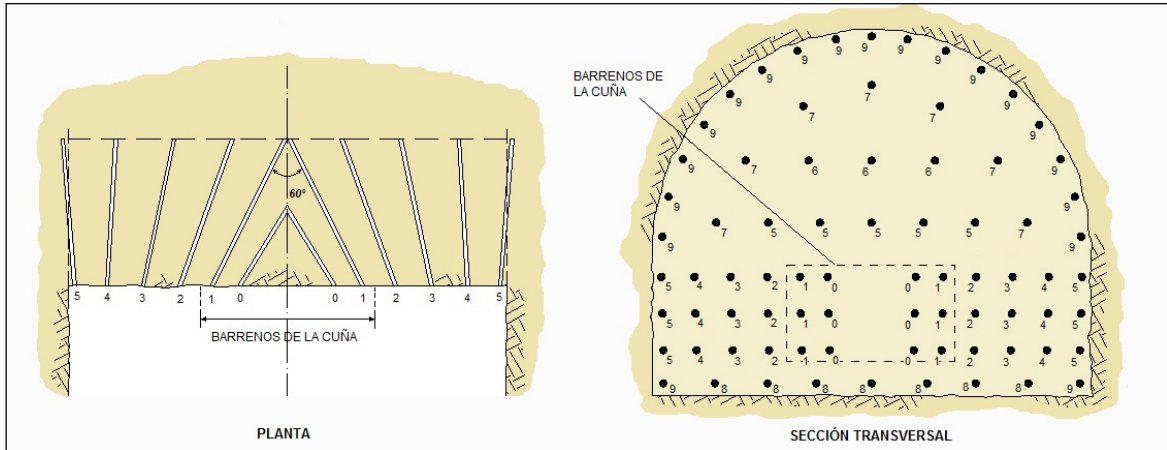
Barrenos para voladura con cuña en V. La numeración en los barrenos muestra cómo sería la secuencia de detonación. [59] López Jimeno (2003)
